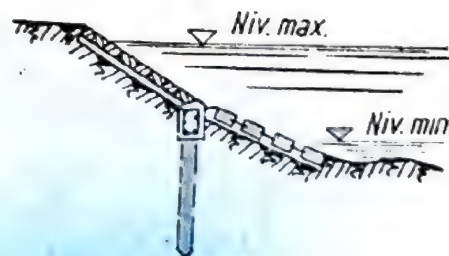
Saltea din dale de beton legate cu grindă de beton armat
